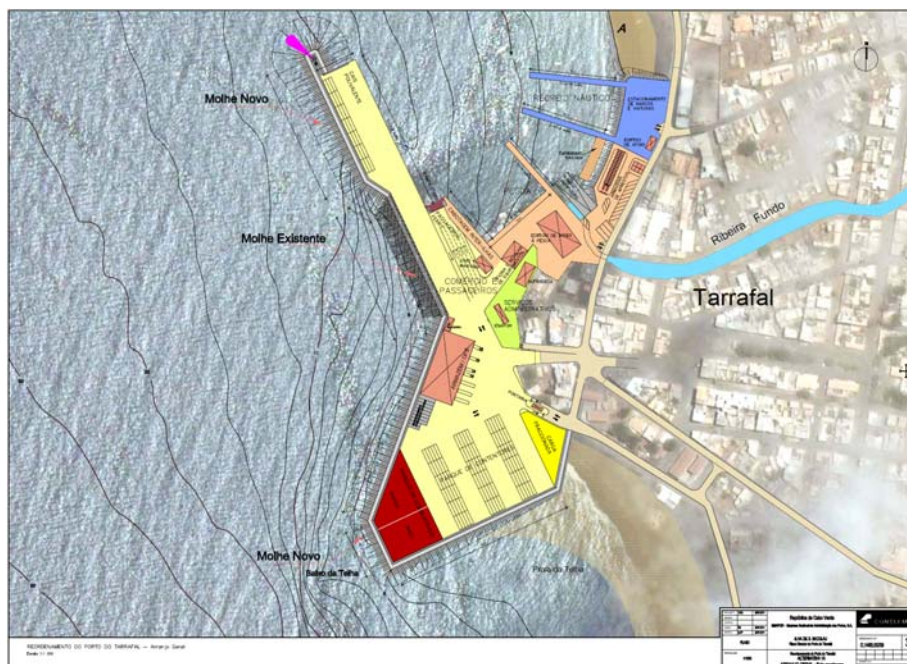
Porto do Tarrafal – Planta Geral da Solução Alternativa 1A
